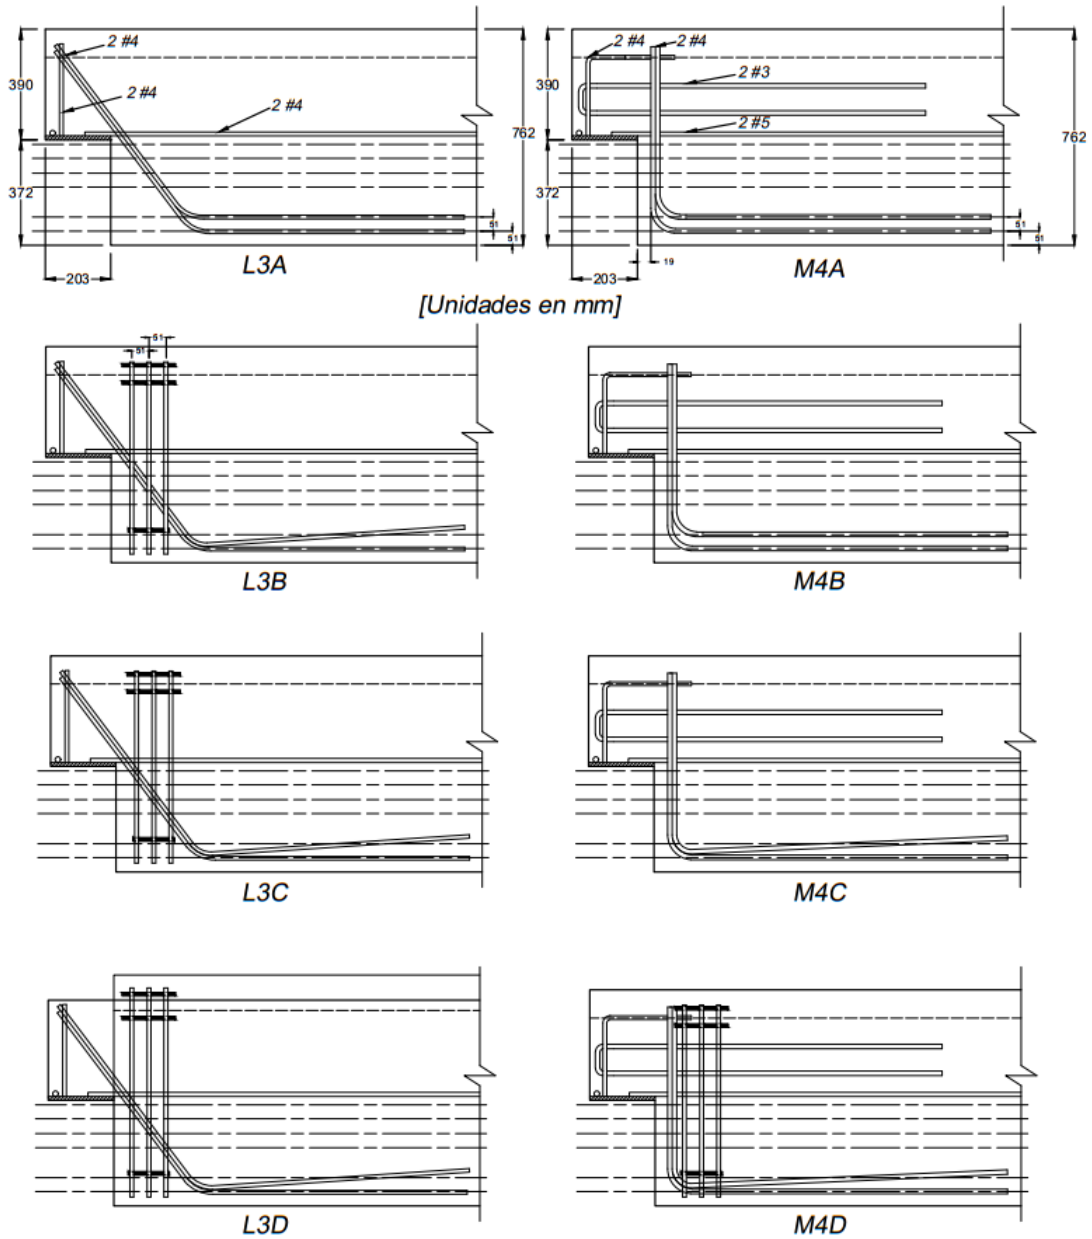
Detalle del armado de los especímenes. (Brinkley, 2013)
